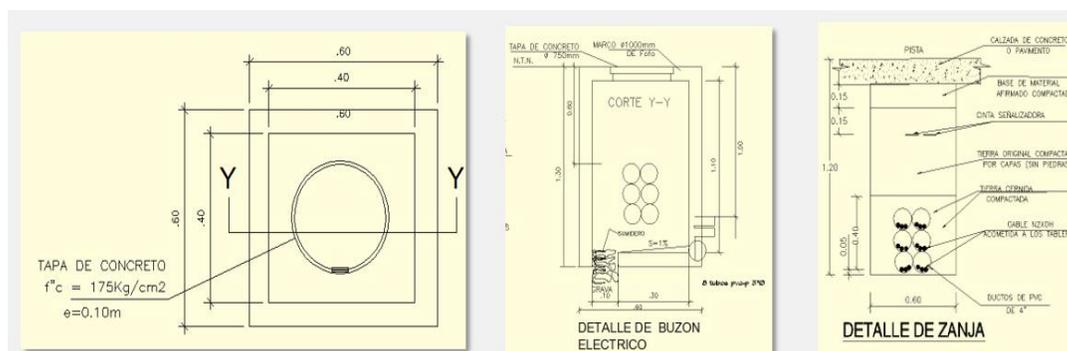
Detalle tapa de concreto, buzón eléctrico y zanja. Fuente Elaboración propia
